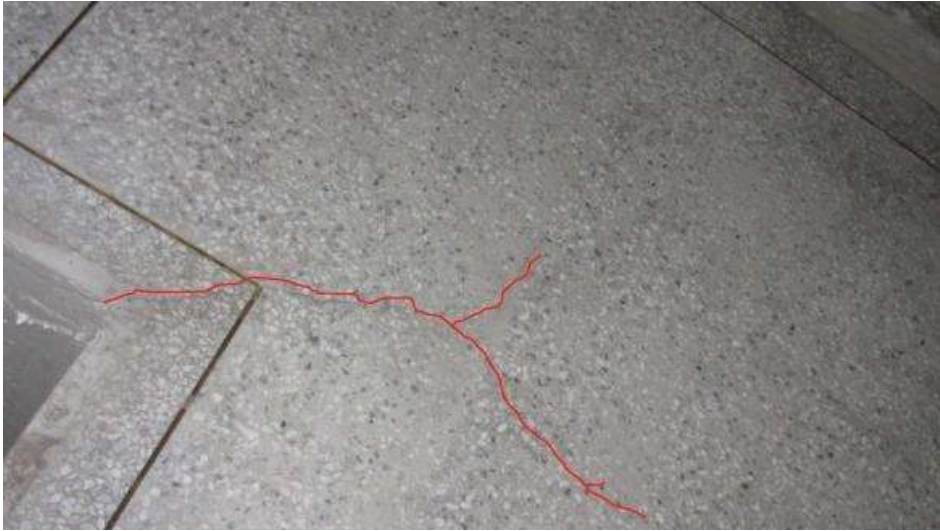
Fisuras en borde de pasa losas (archivo propio)
